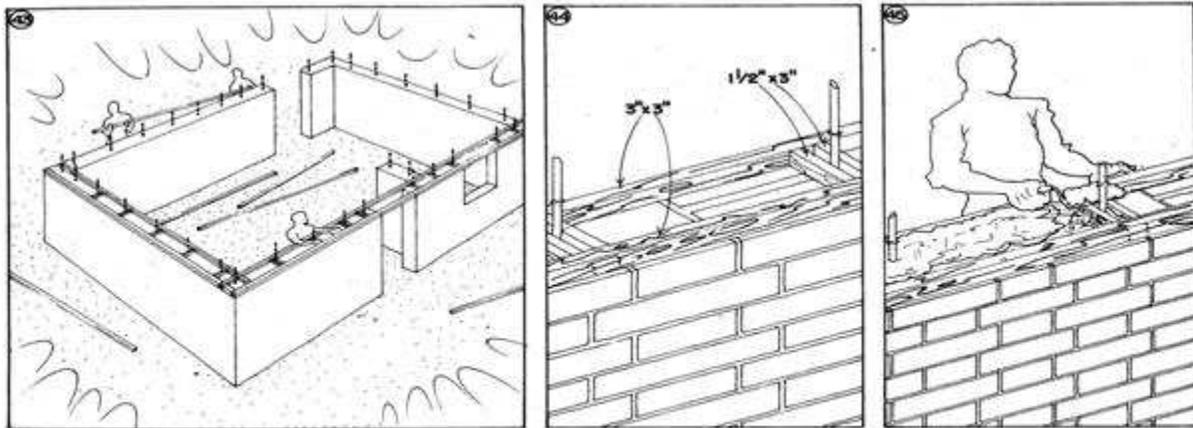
Guía para la Construcción de Muros con Contrafuertes y Pilastras (IAEE 1986)
